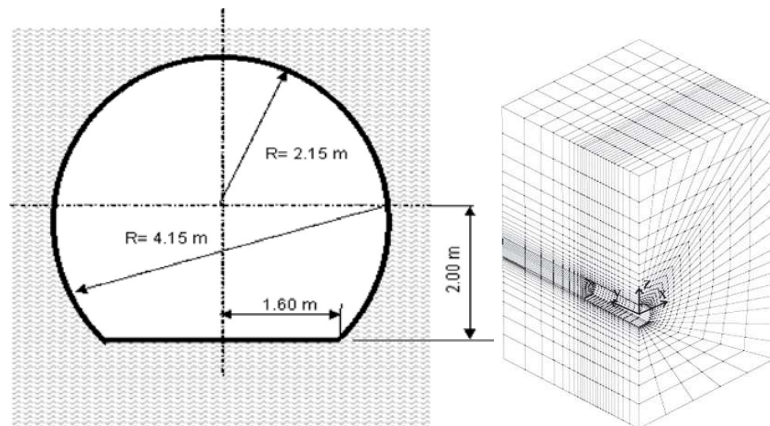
Dimensões da escavação e modelagem 3D (PELLET; ROOSEFID; DELERUYELLE, 2009).
